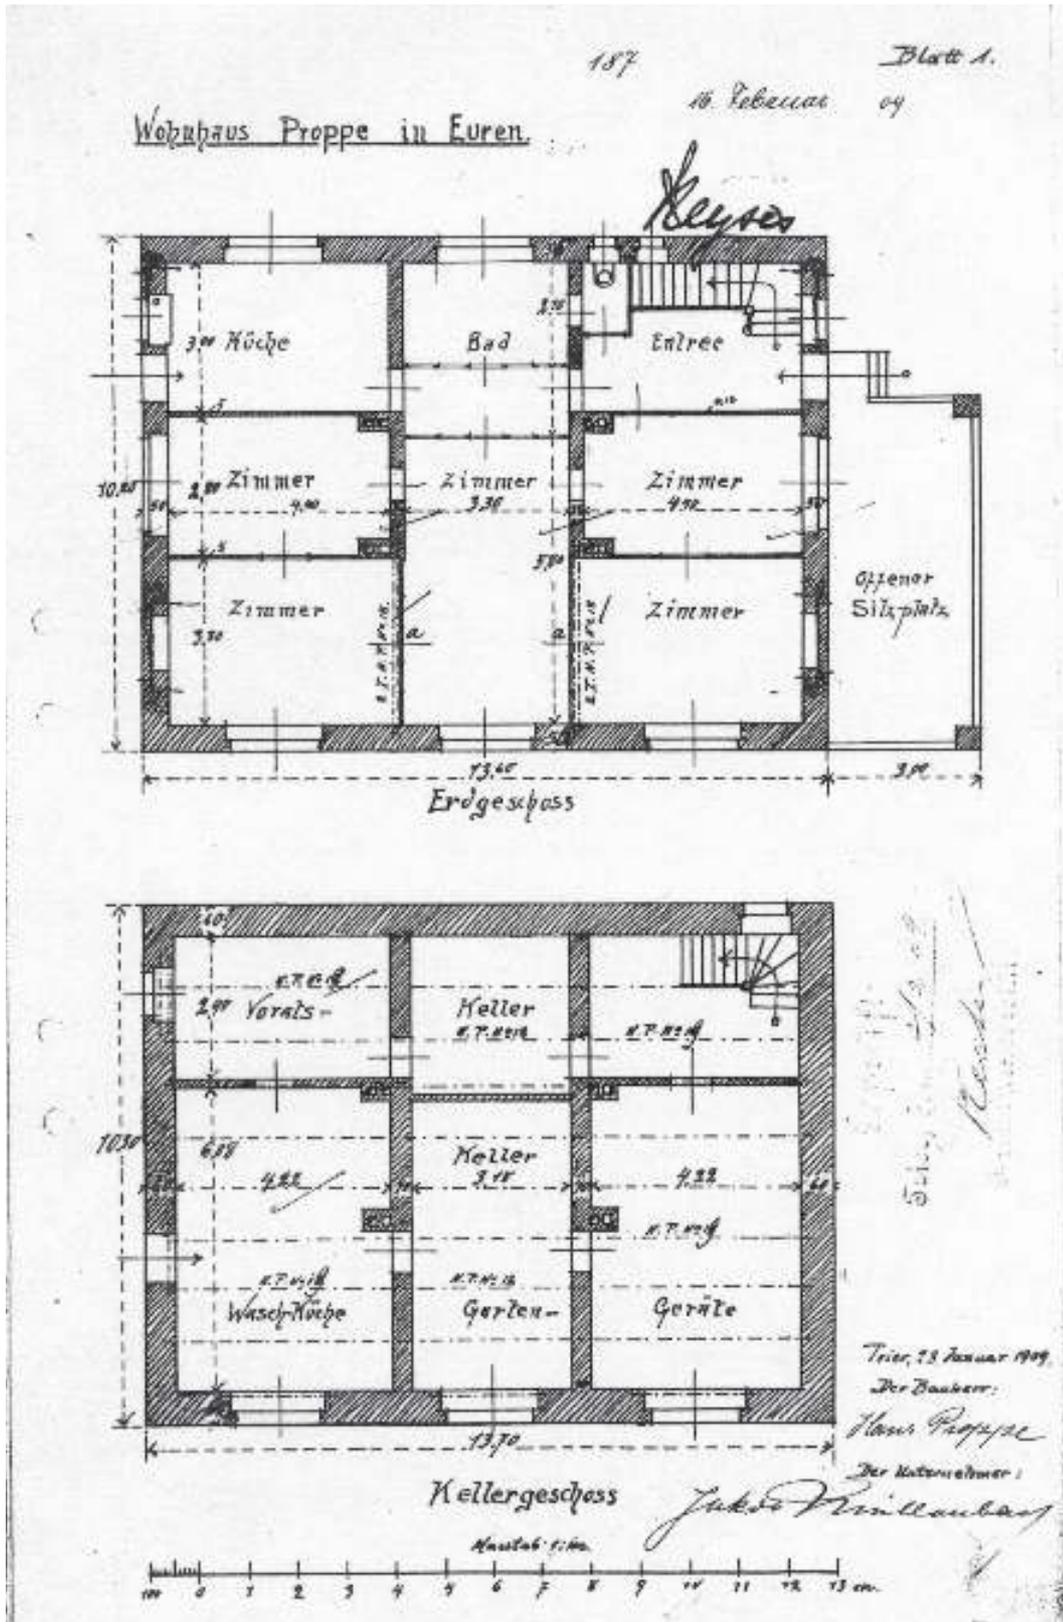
Haus Proppe, Bauplan, Blatt 1, Grundrisse Erd- und Kellergeschoss
